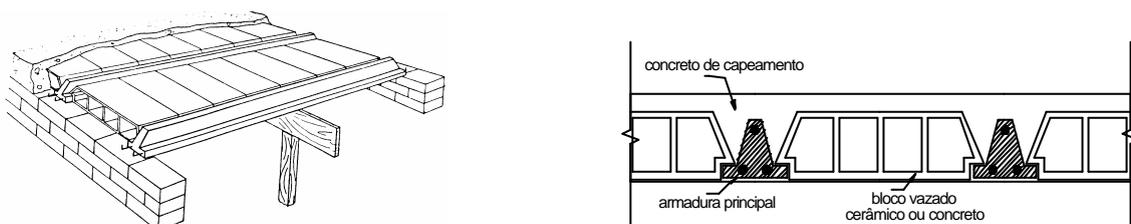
Perspectiva esquemática da montagem da laje pré fabricada com vigota do tipo trilho (adaptada de Borges 1997) e seção transversal após o preenchimento de concreto
